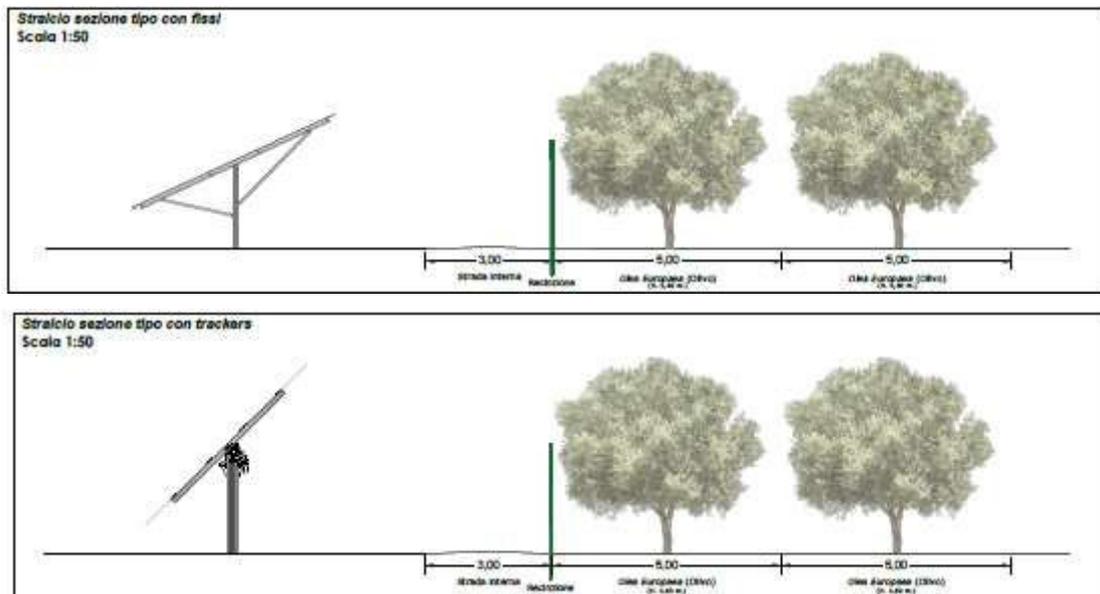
Stralcio sezioni tipo su fissi e su trackers fascia di mitigazione
